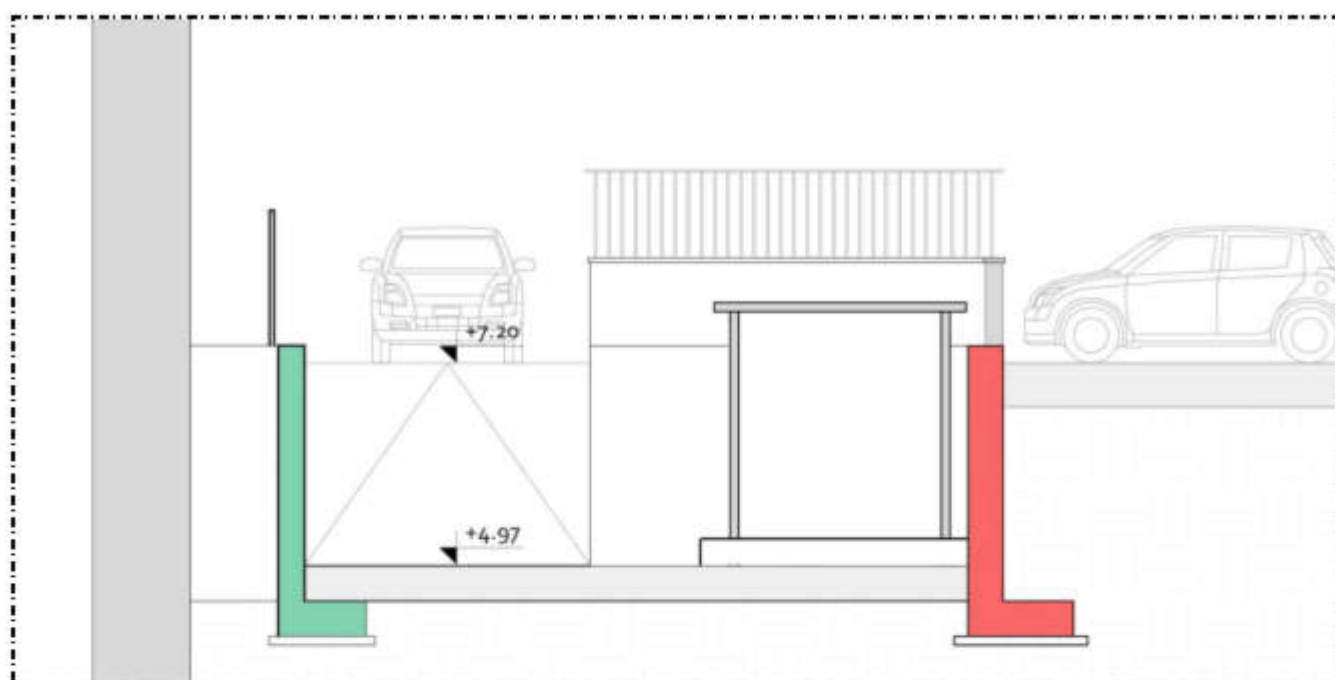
Sezione trasversale con individuazione della nuova cabina ENEL e della nuova rampa di accesso
